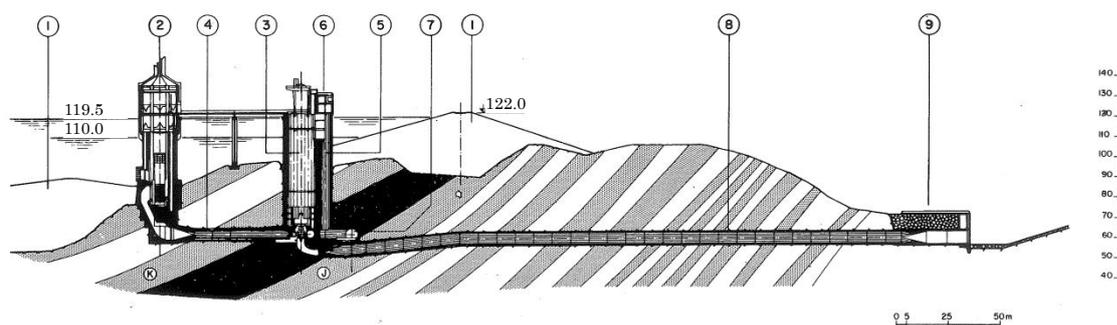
Plan de terrain du barrage de Sidi Salem
